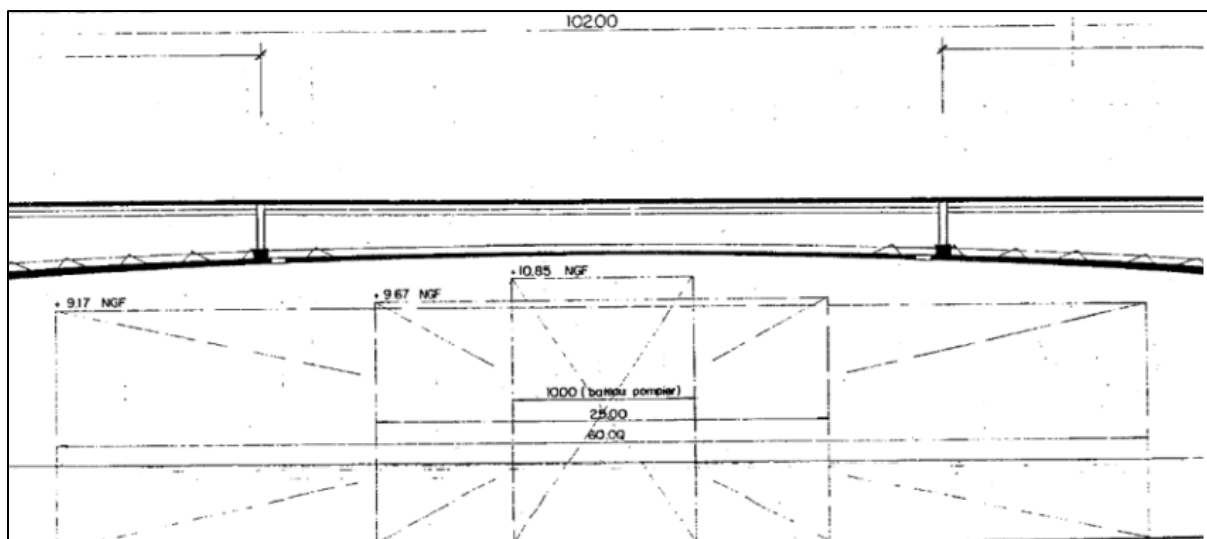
Passes navigables entre les piles P2/P3 et P3/P4 (extrait plans DOE)
